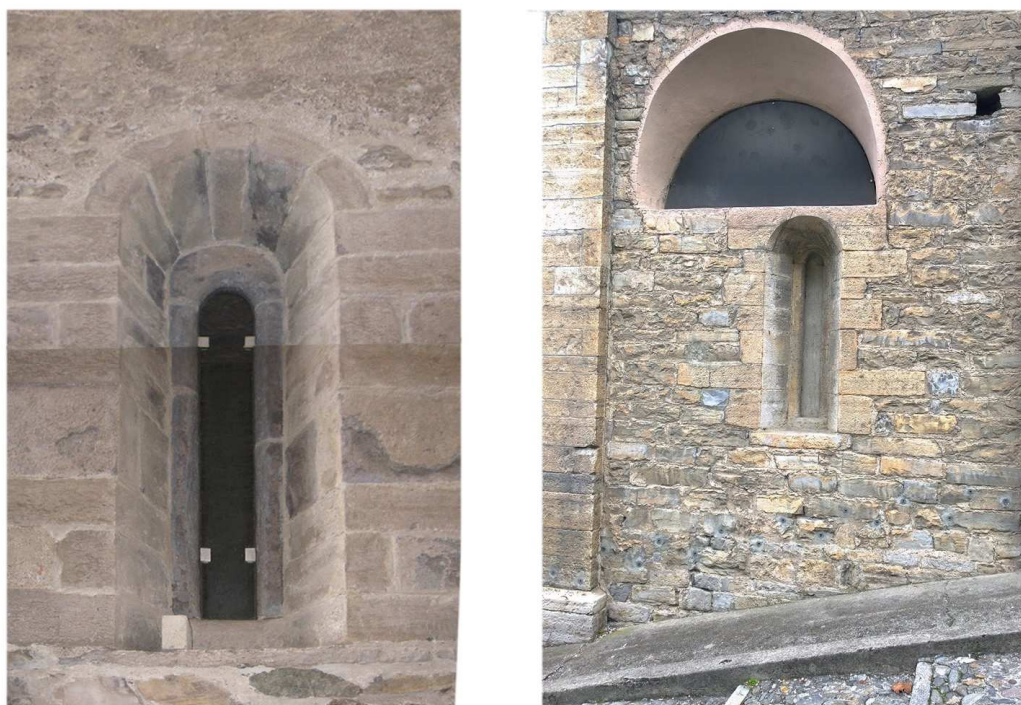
Muratura perimetrale sud — dettaglio 2 (foto dell'Autore).
